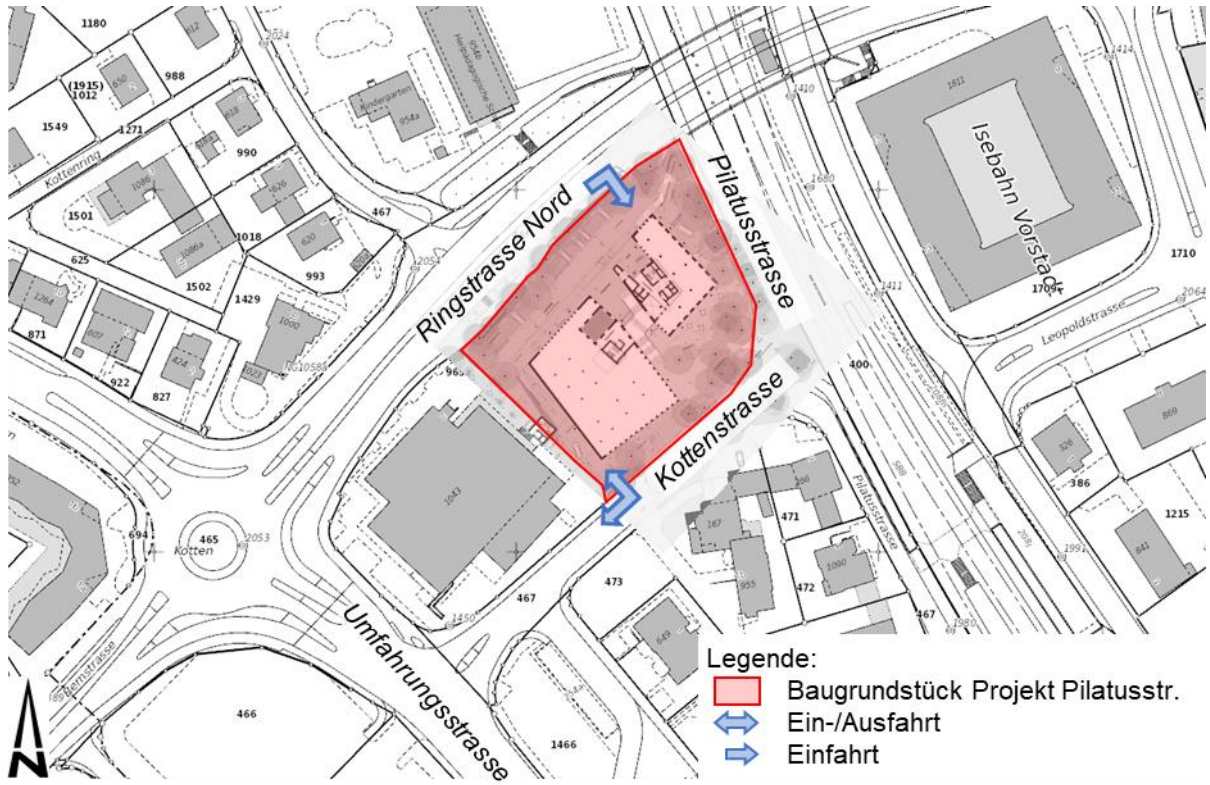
Situation und Erschliessung Projekt Pilatusstrasse (Plangrundlage [1], [7])
